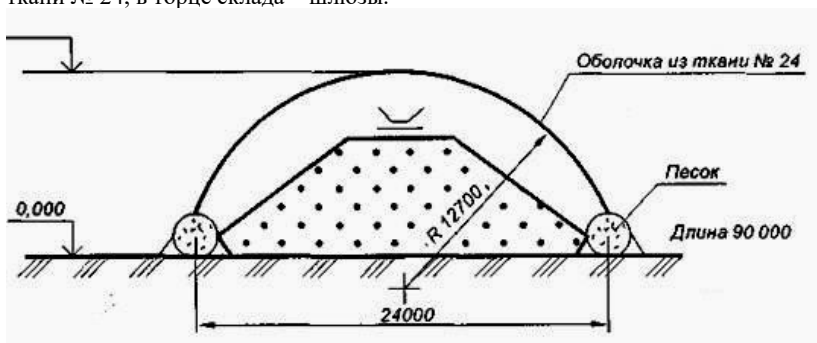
Пневматический склад воздухонапорной конструкции
